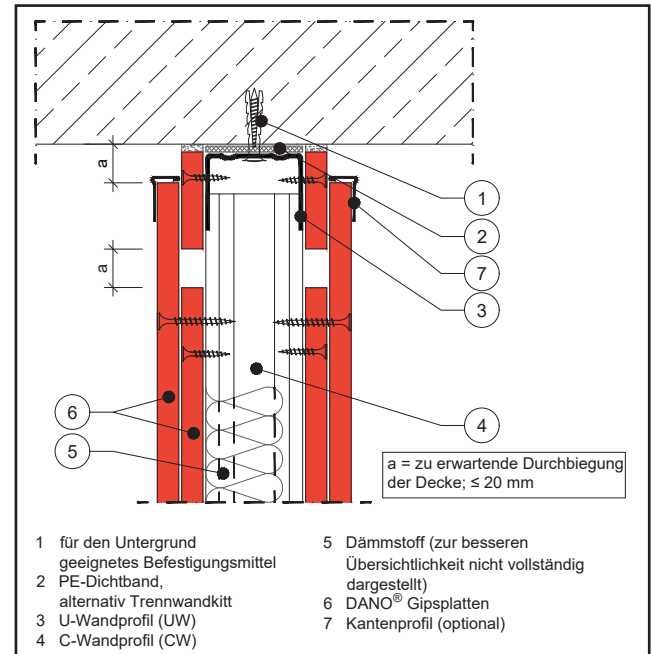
Gleitender Deckenanschluss mit Plattenstreifen
